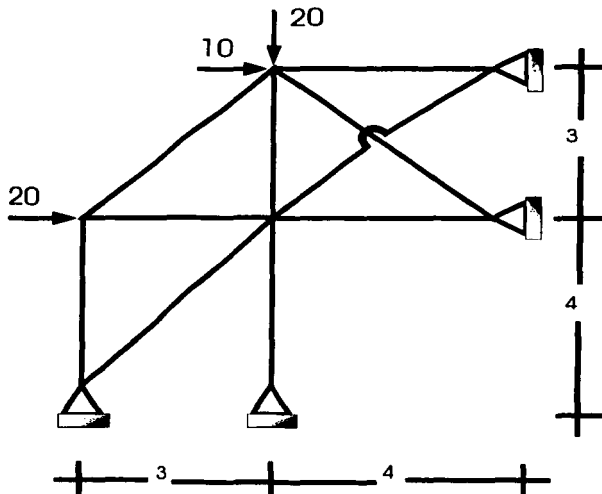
Geometría de la armadura y cargas impuestas a la misma.
